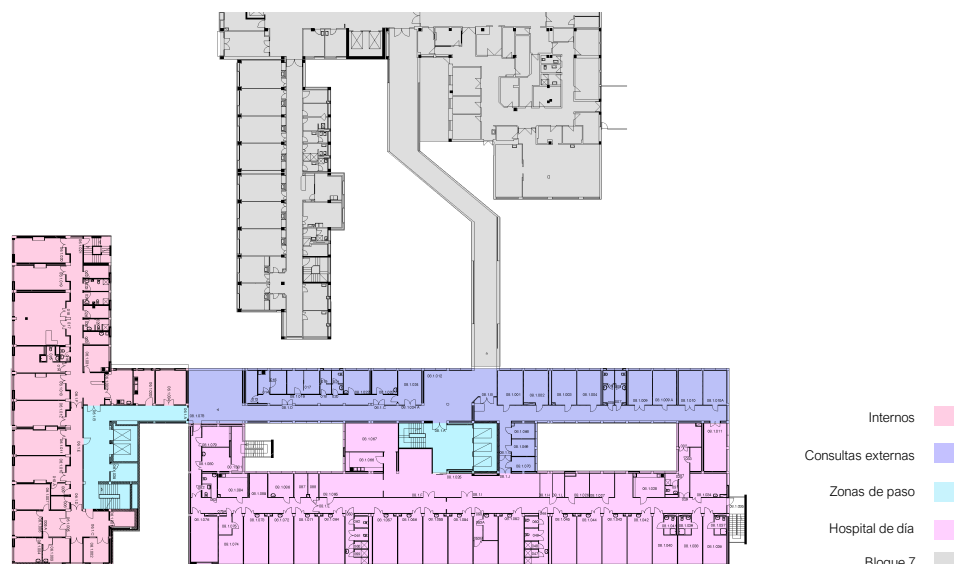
Primera planta bloques 6/8. Análisis de distribución de áreas. Plano base oficial facilitado por el Ingeniero Paulo Costa. Análisis gráfico realizado por Laura Castro.
